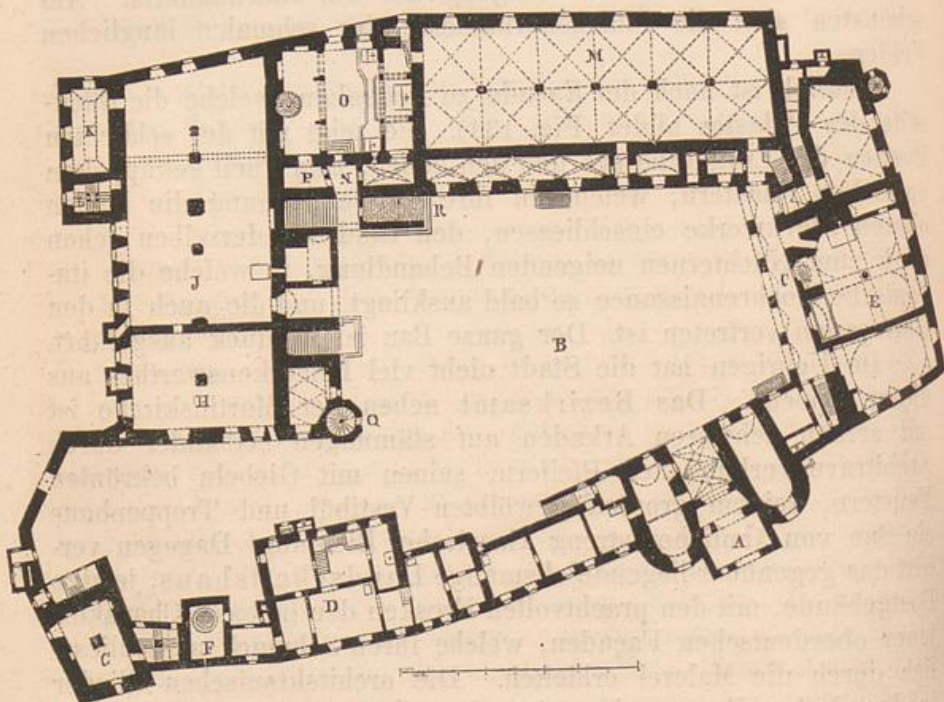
Trausnitz. Grundriss des Erdgeschosses.
